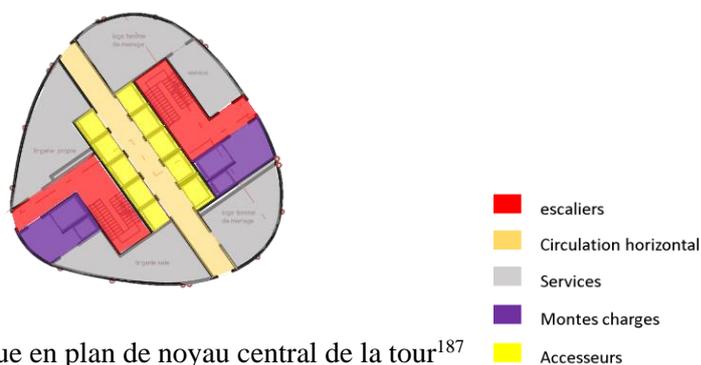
Vue en plan de noyau central de la tour¹⁸⁷
